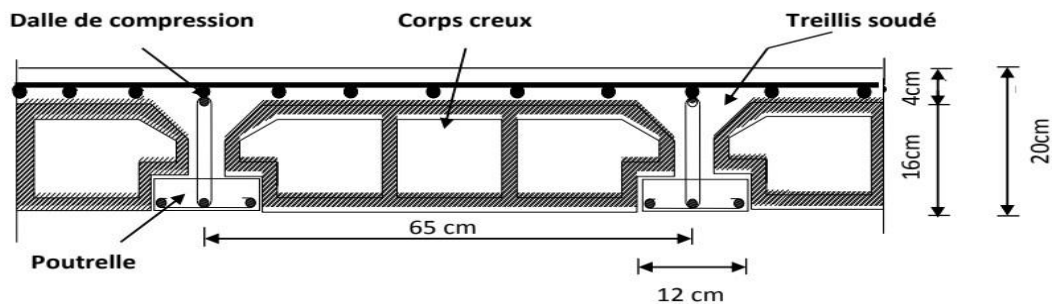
coupe transversale dans un plancher en corps creux
